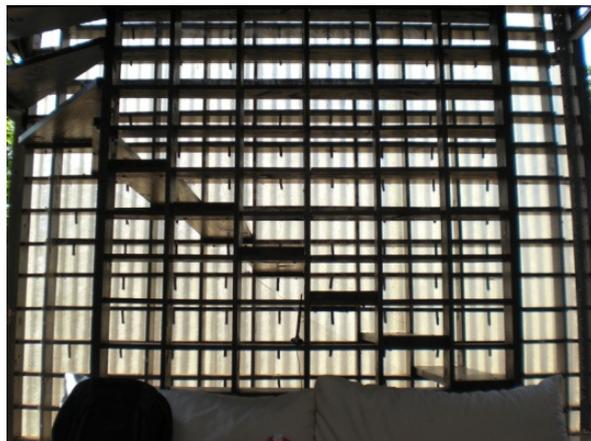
Vista interna da fachada da Unidade 001. Fonte: Autor
